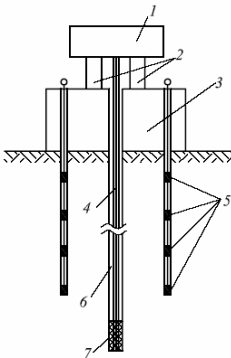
Схема штамповых испытаний скальных грунтов с применением тросового анкера:
